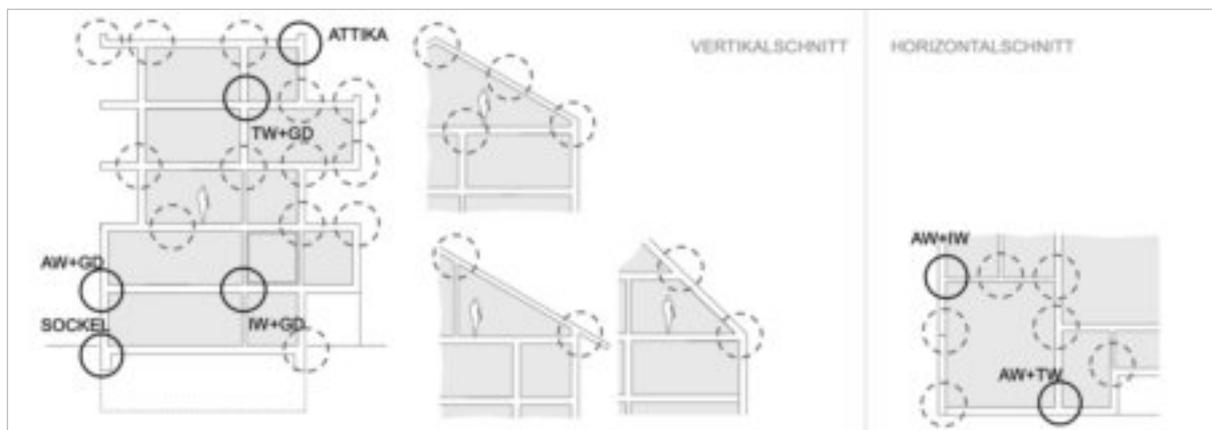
Ausgewählte (schwarz) und zukünftig noch zu bearbeitende Detailpunkte (grau) in Schnitt und Grundriss, Quelle: Forschungsbericht, Grafik: M. Kohaus
